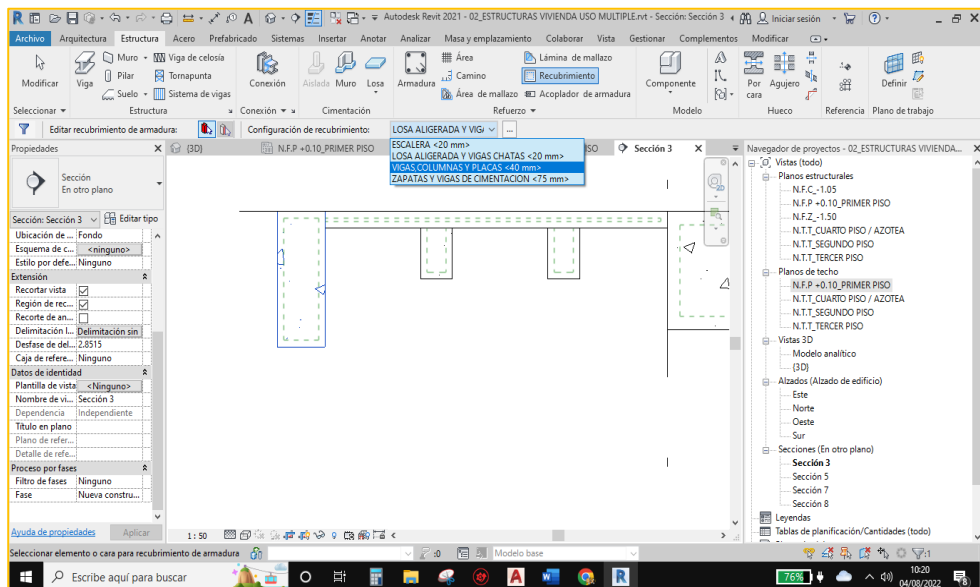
Configuración de recubrimientos de vigas, columnas y placas.
